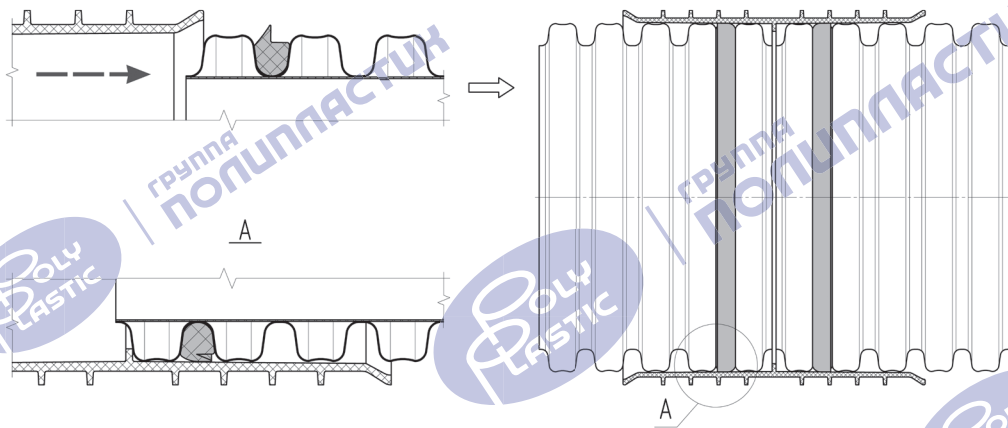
Схема соединения труб. Установка уплотнительного кольца в первую впадину гофра
